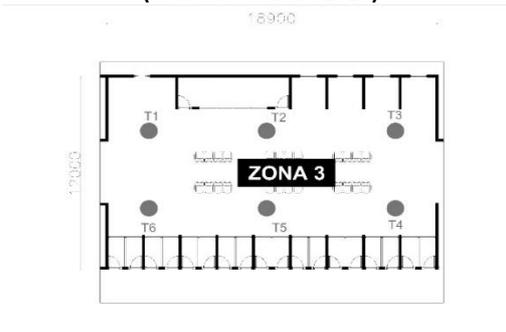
Denah Eksisting Pengukuran (Sumber : Penulis 2023)
